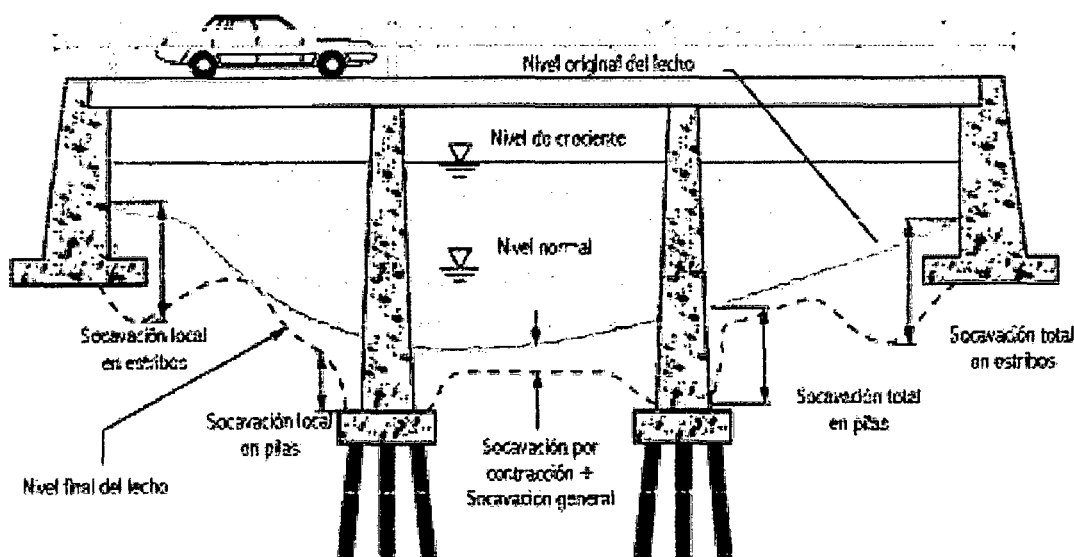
Tipos de socavación que pueden ocurrir en un puente.
